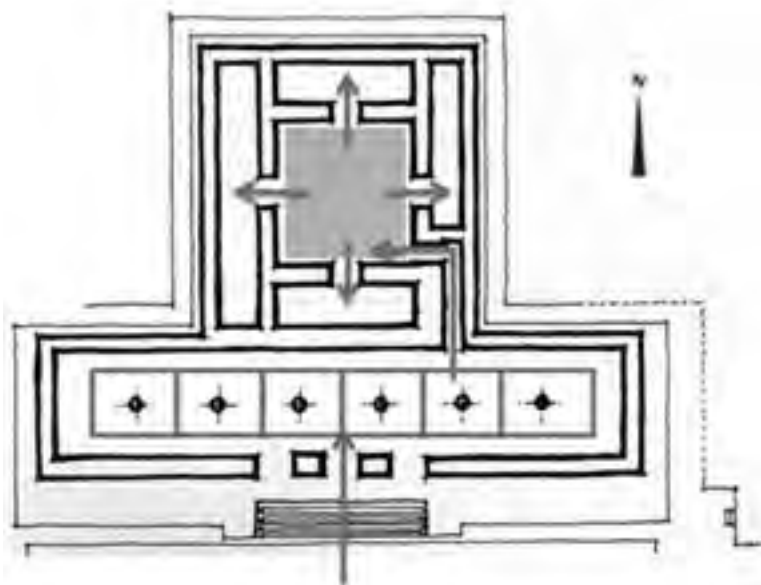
Plano de circulaciones en el Conjunto de las Columnas en Mitla. Fuente: elaboración propia.
